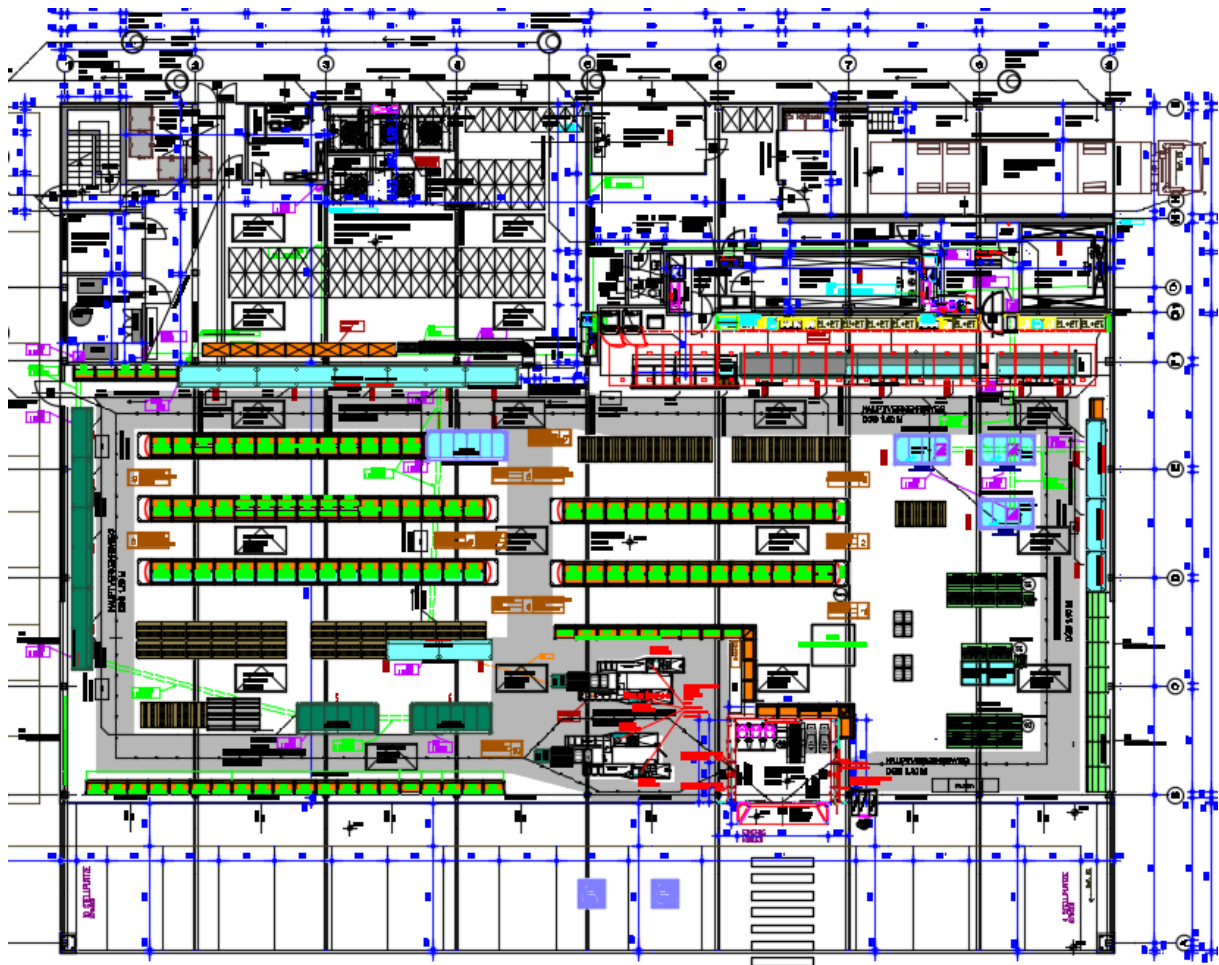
Innenbereich des Einkaufsmarktes, Grundriss Vogau
